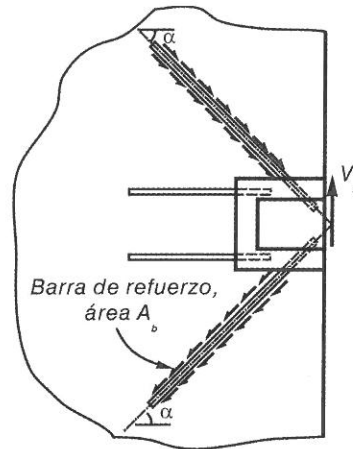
Detalle del anclaje de las platinas de acero embebidas en los paneles.
